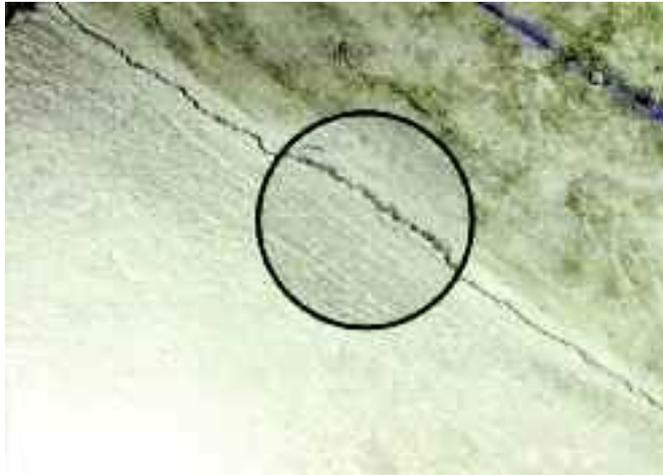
fissure au niveau d'une reprise de bétonnage due aux vibrations (crédit photo D. Poineau)
